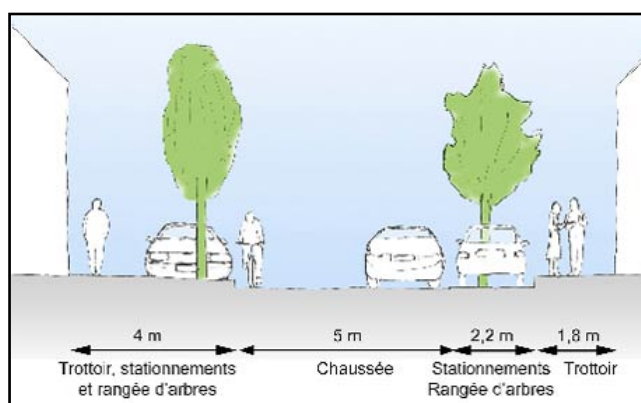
Rues du lotissement qui desservent les maisons, les autres rues et les ruelles
